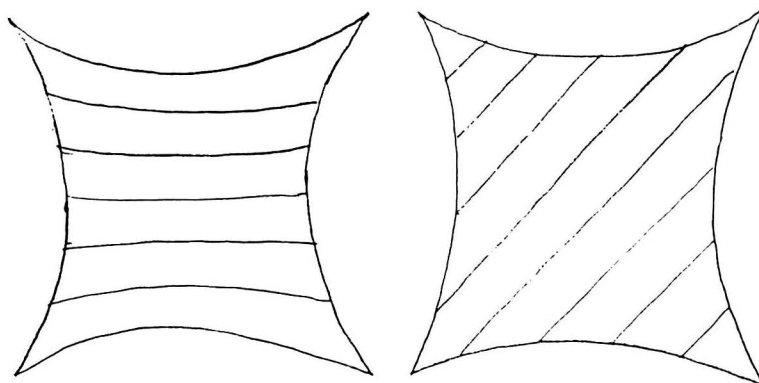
DESPIECES DE UN PARABOLOIDE HIPERBOLICO
